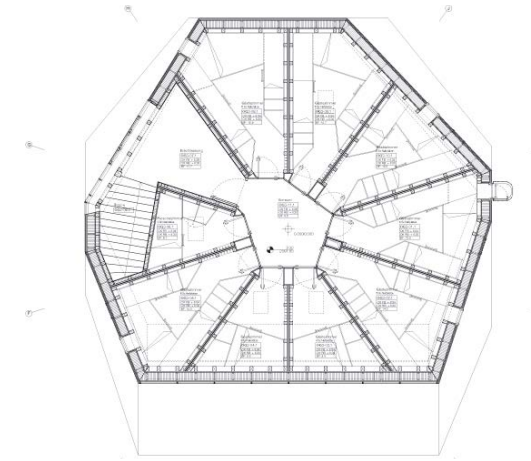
Pianta piano terzo del Monte Rosa Hütte
